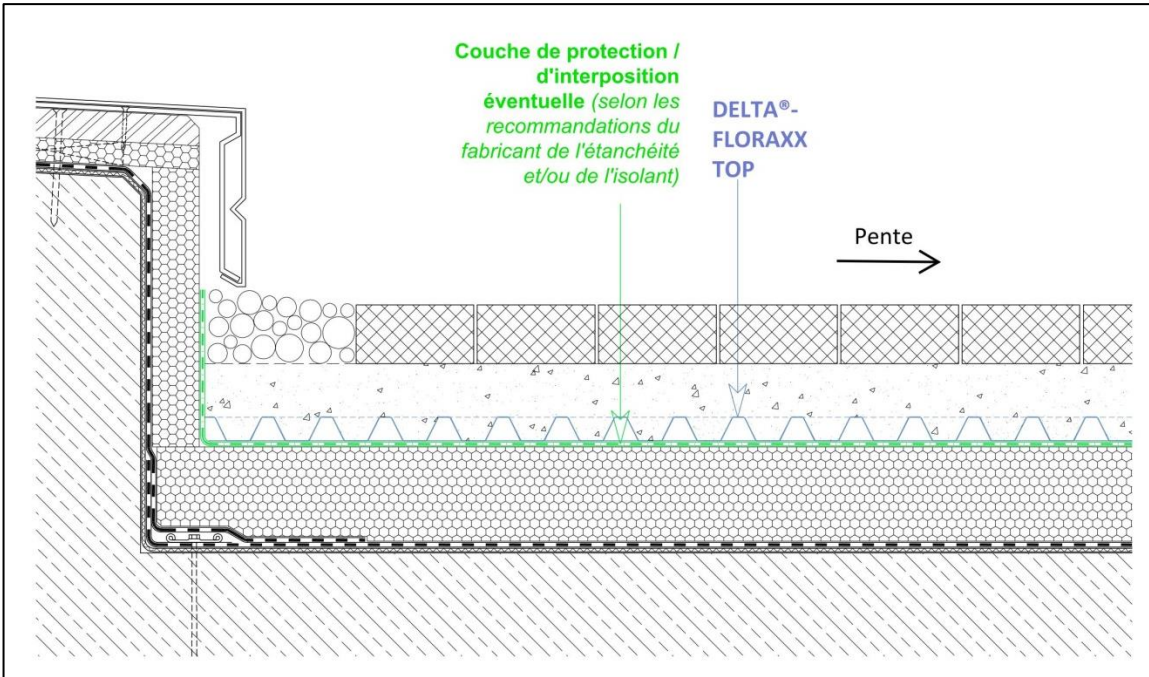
traitement des relevés en acrotère avec membrane d'étanchéité avec isolation inversée de toiture + DELTA®-FLORAXX TOP (protection lourde avec dalles ou pavés)
